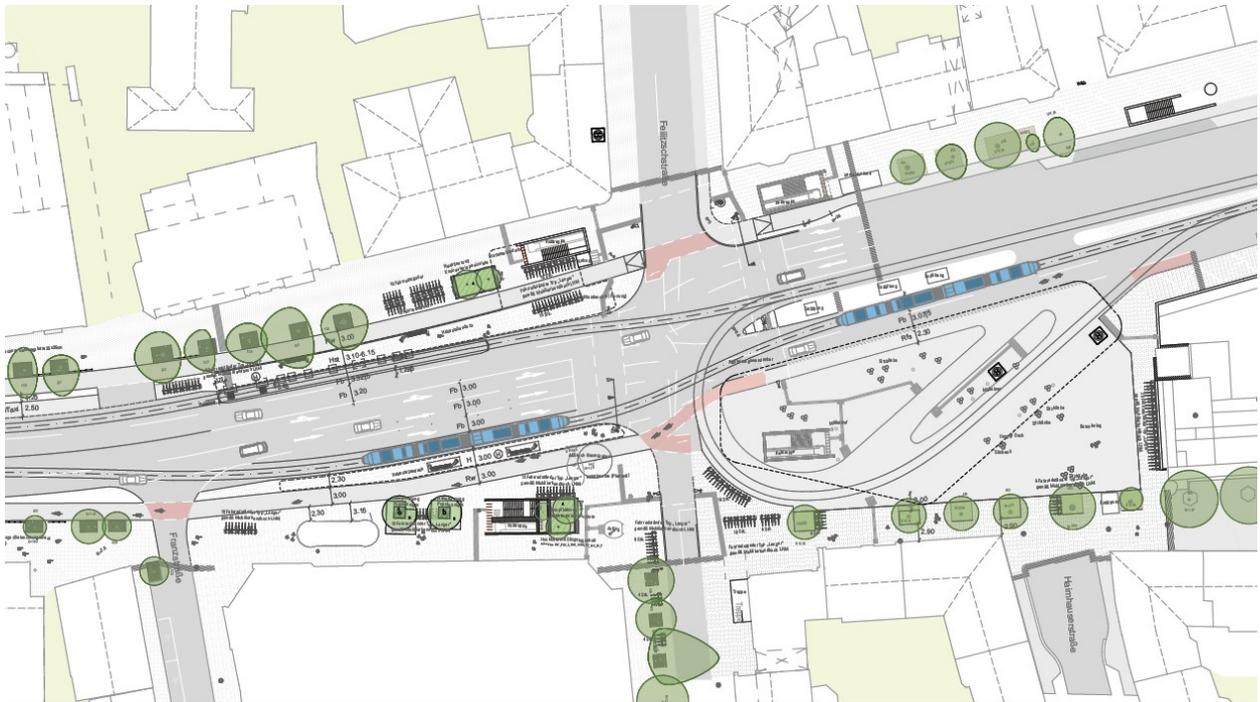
Lageplan V1 (Quelle: SWM/MVG, mgk Landschaftsarchitekten)
